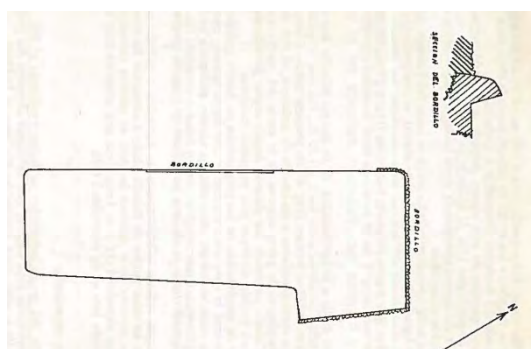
Croquis original del espacio pavimentado en *opus signinum*, con un detalle del reborde (Taboada Chivite, 1966-68: 196).
